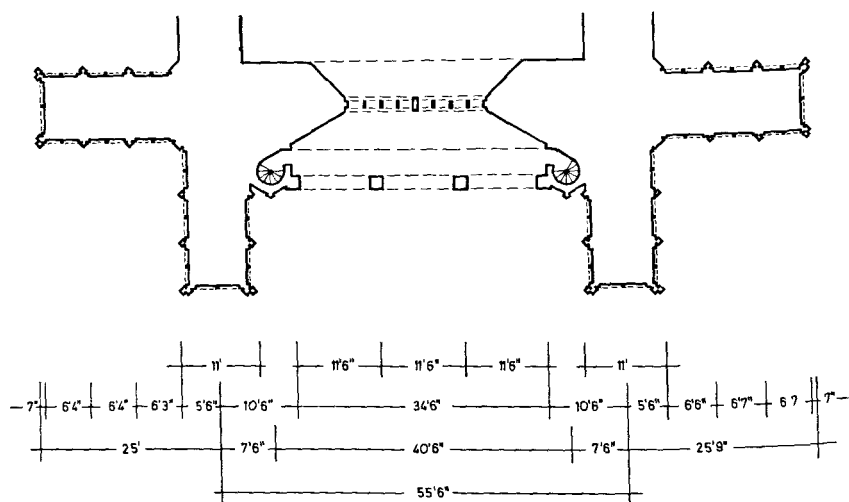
Ulm Münsterturm Riß C, schematischer Grundriß des Martinsgeschosses.
